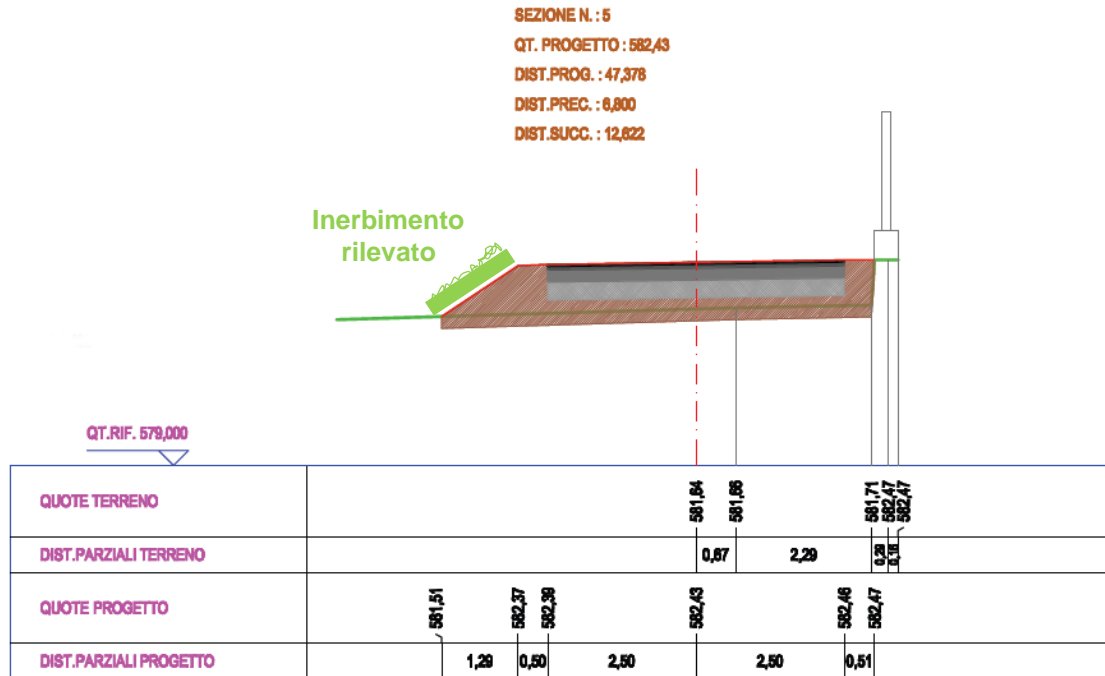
Sezione tipo della strada di accesso con intervento di inerbimento del rilevato
